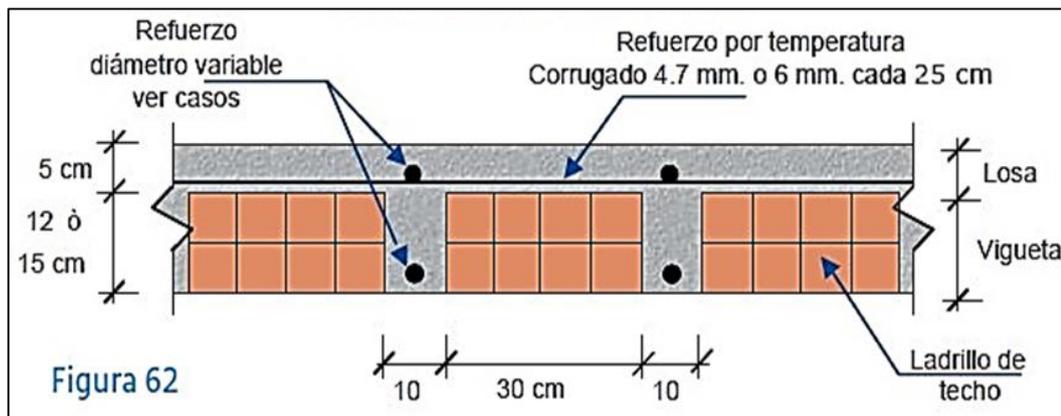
CARACTERÍSTICAS DE UNA LOSA ALIGERADA
